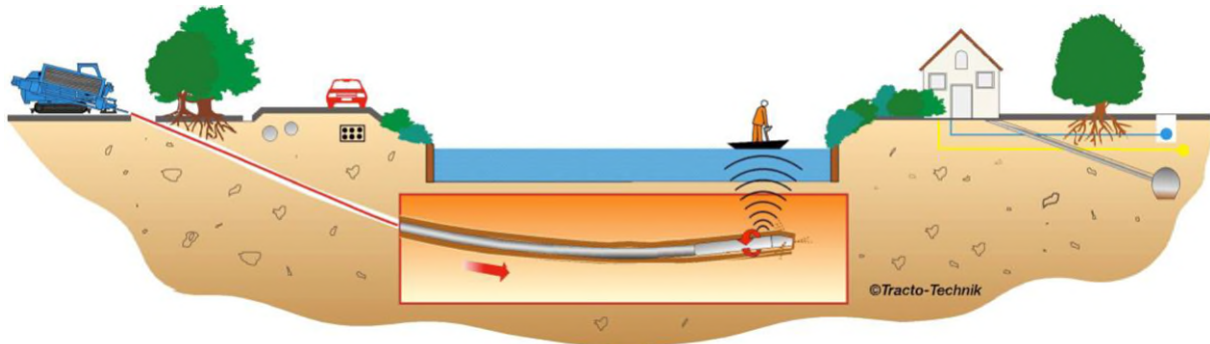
Pilotbohrung mit Ortung (HDD; www.horizontalbohren.de)
